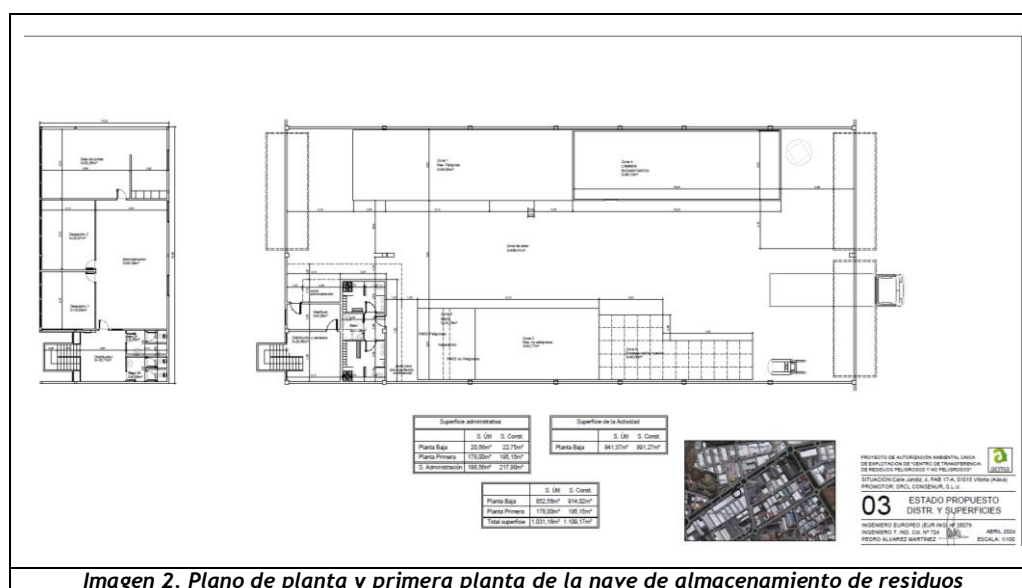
Plano de planta y primera planta de la nave de almacenamiento de residuos
